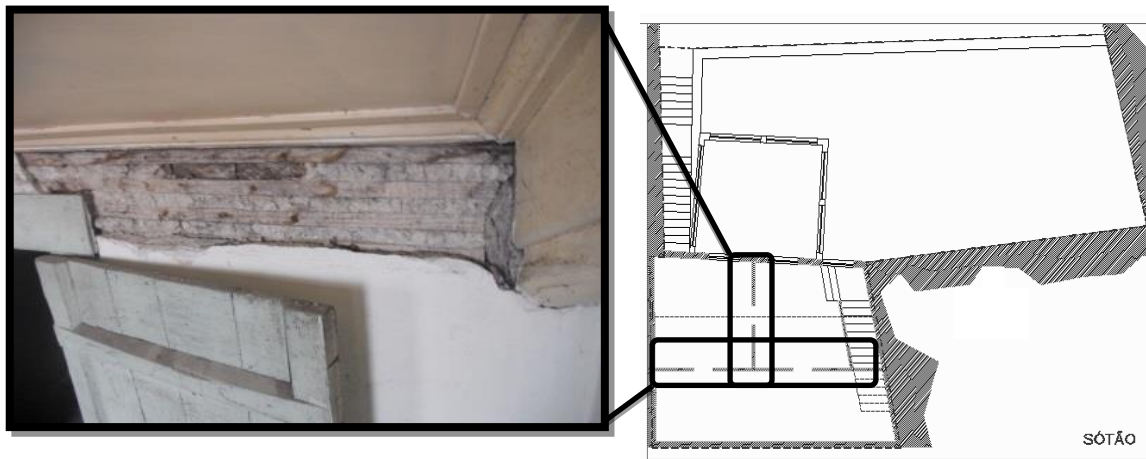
Anomalia 16 - Fotografia e localização em planta
